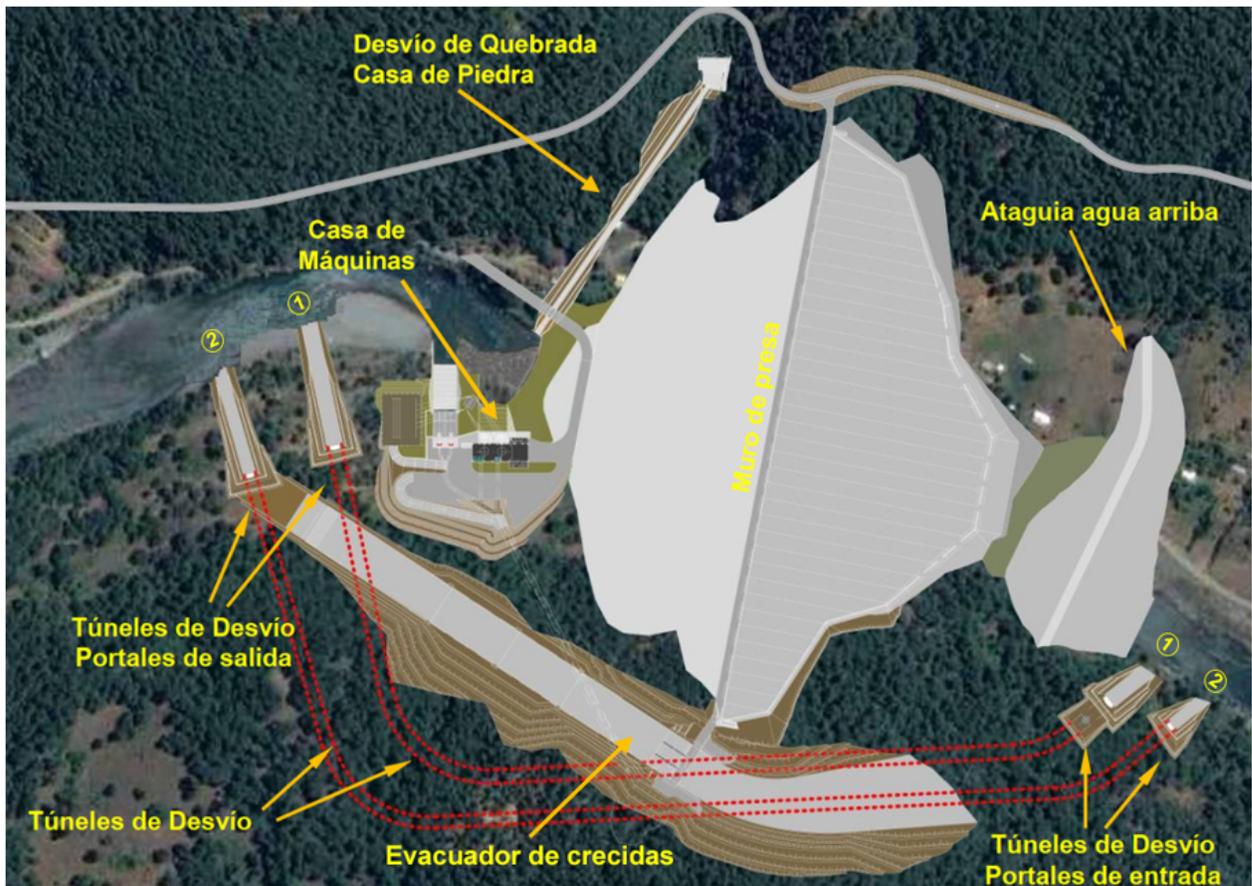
Vista en planta de las obras. Fuente: Astaldi (2015).
